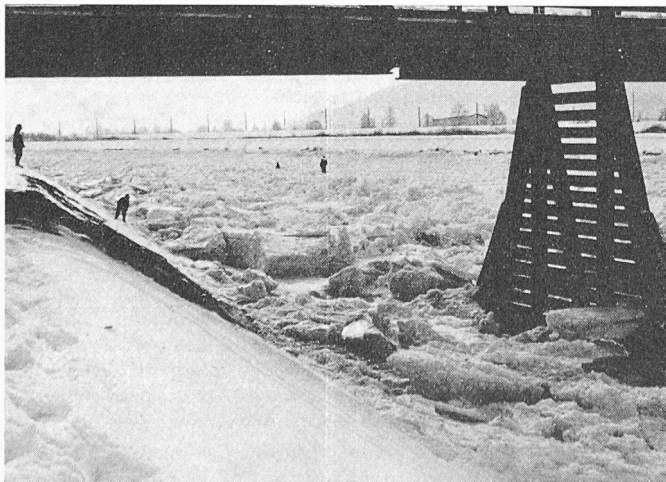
Eisgang auf dem Rhein bei der Brücke Monstein während der Erstellung der Fundationen (Winter 1955/56).
